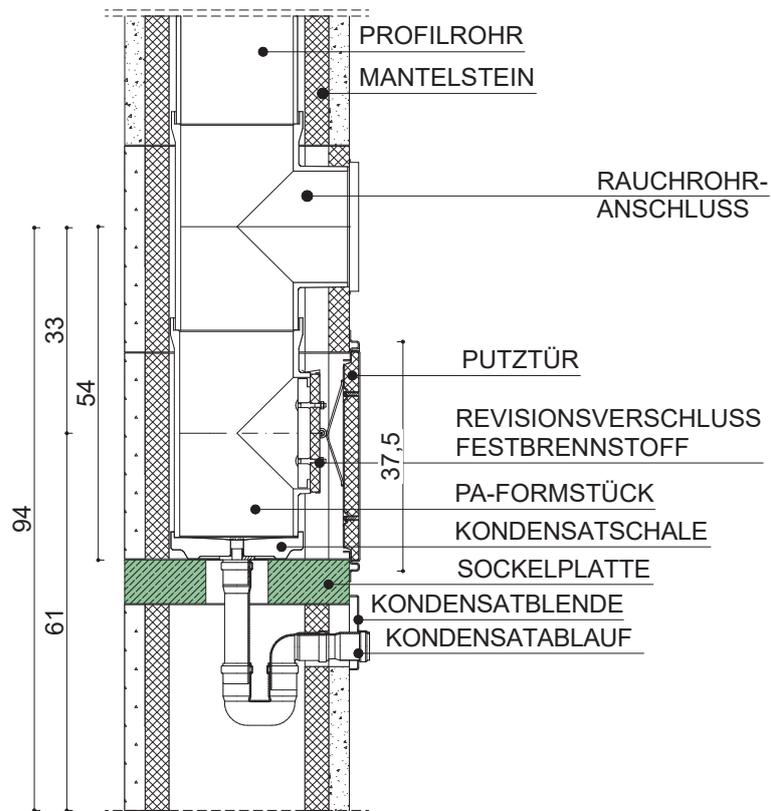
Detail Rauchrohranschluss (Schiedl Kamin)
